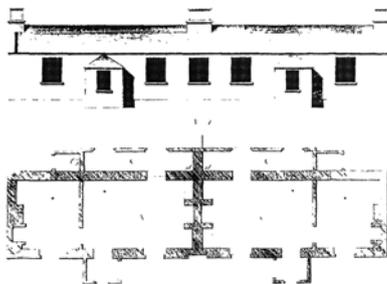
Zweizimmercottage mit Windfang nach J. Wood, 1777 (l)
